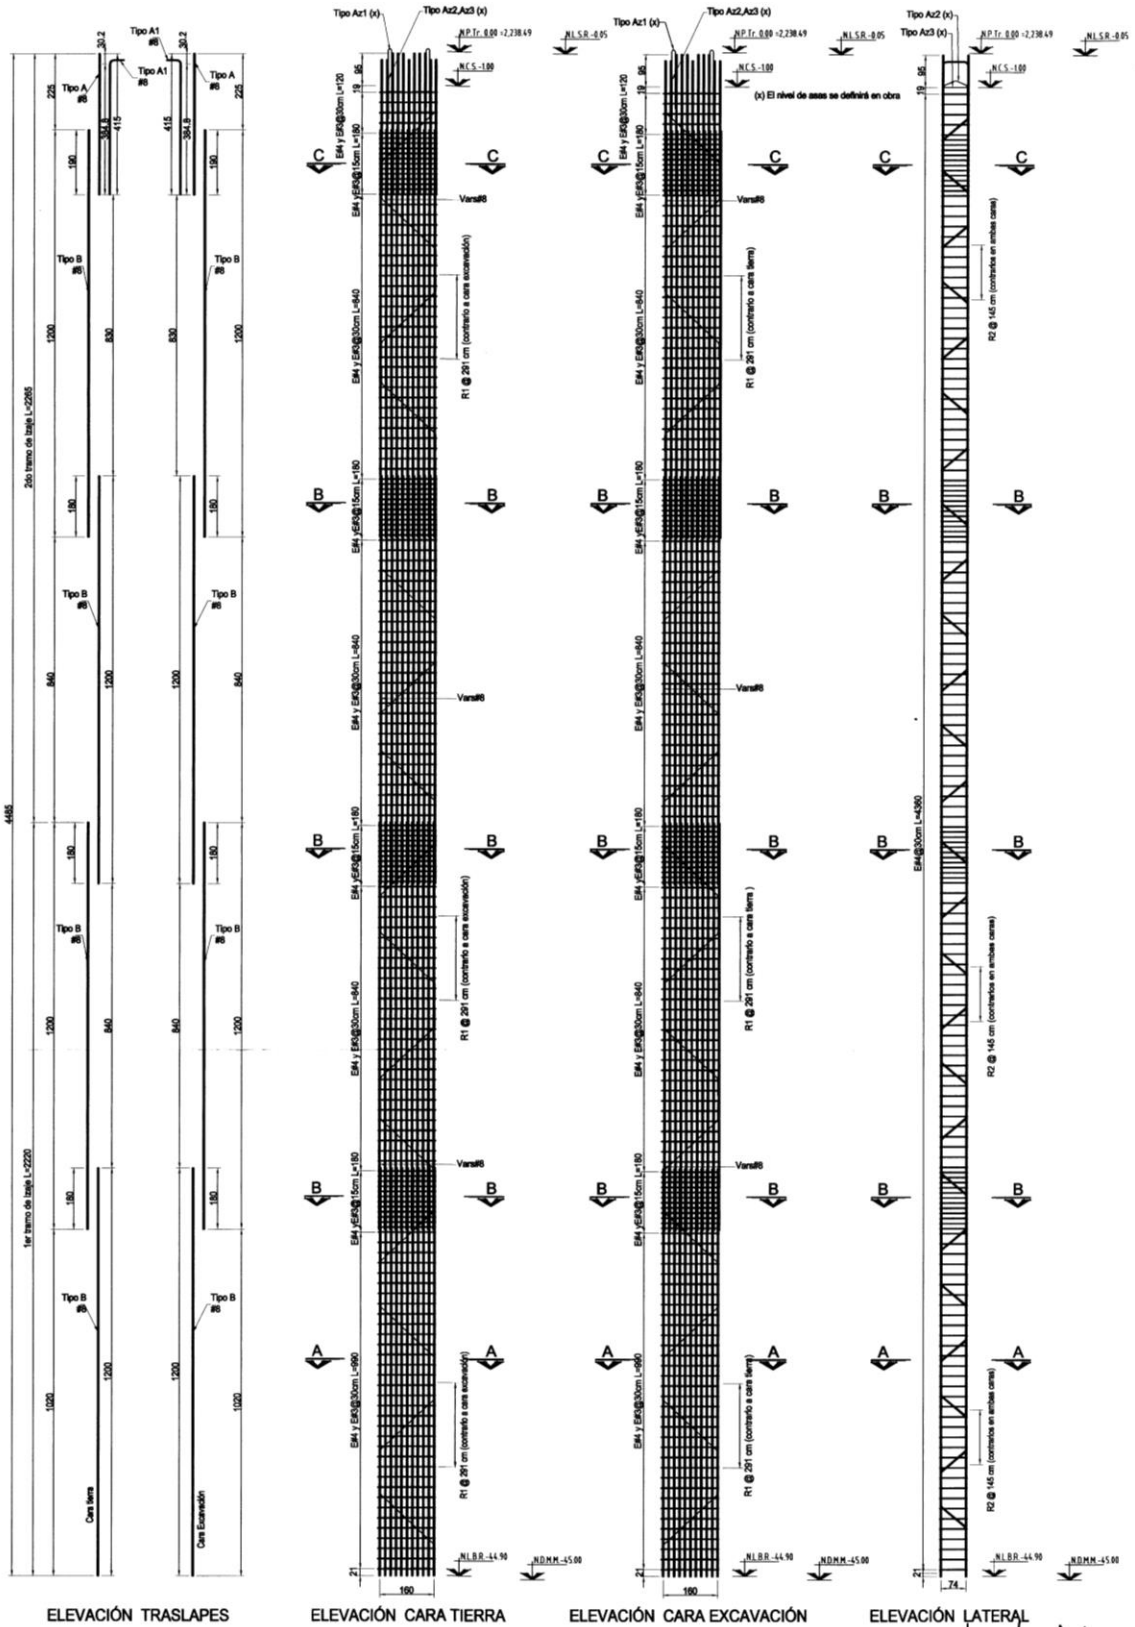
Acero de refuerzo utilizado para los paneles del muro Millán.
